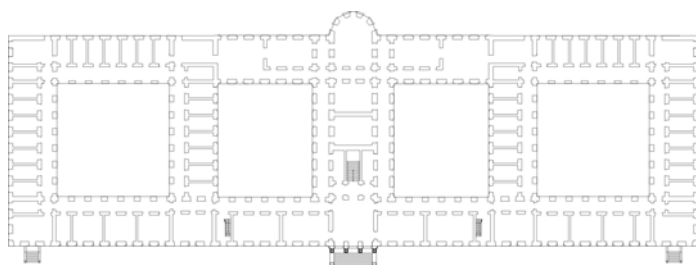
Planta do Hospício Pedro II, segundo sua concepção original.
